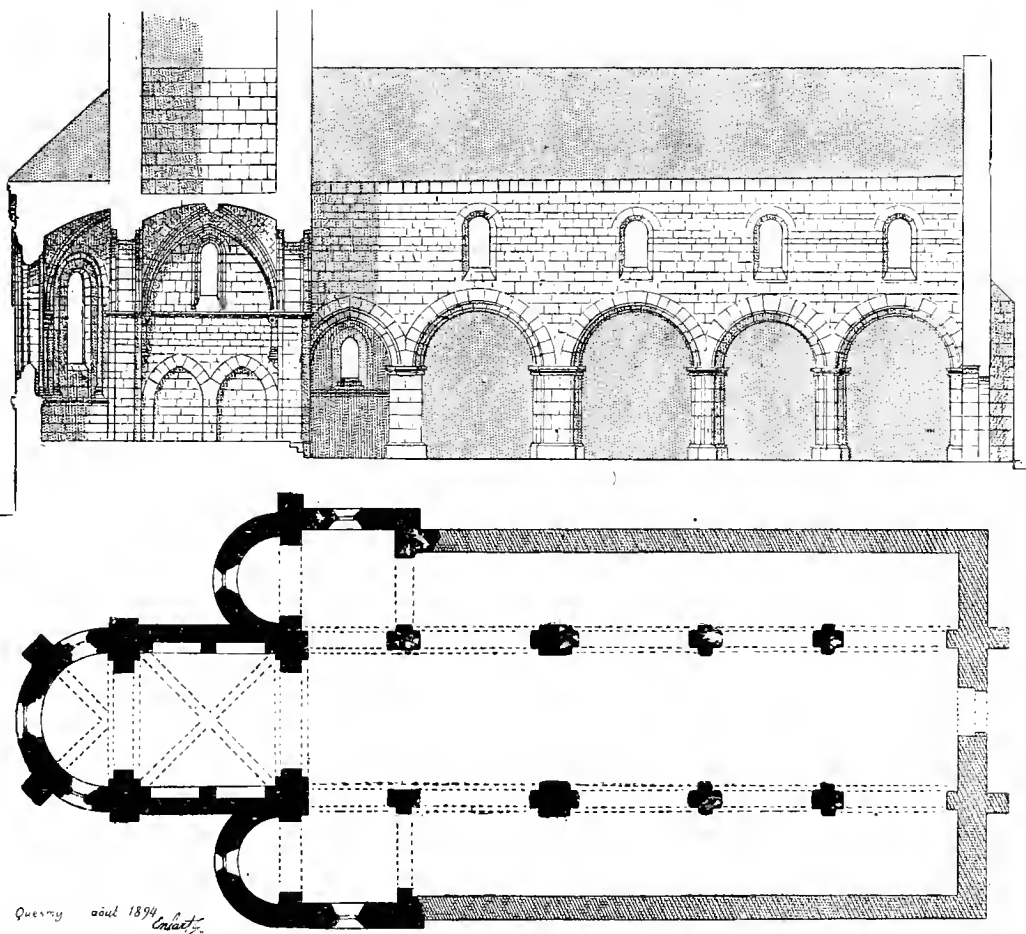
Plan et coupe de l'église de Quesmy (Oise).
